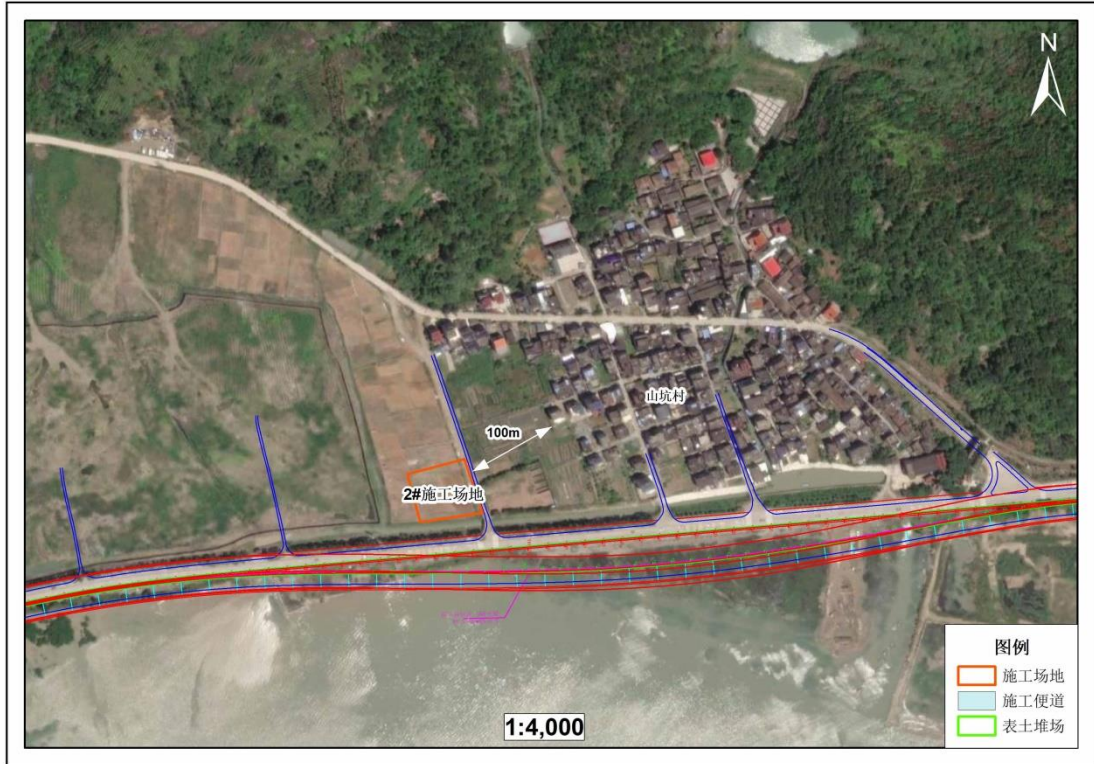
临时工程平面布置示意图（2#施工场地）
